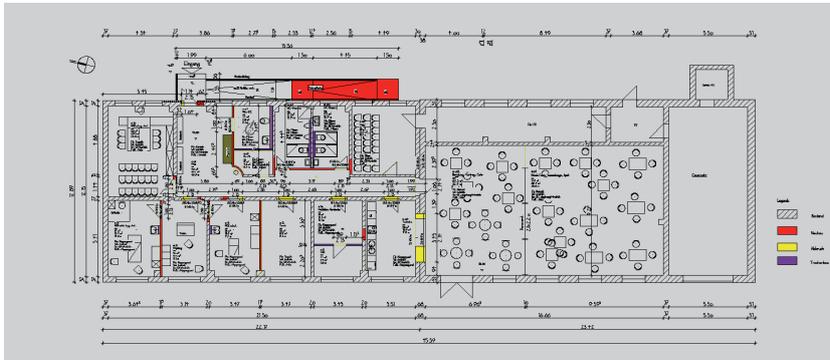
Grundriss „Alte Schule m.H.“
